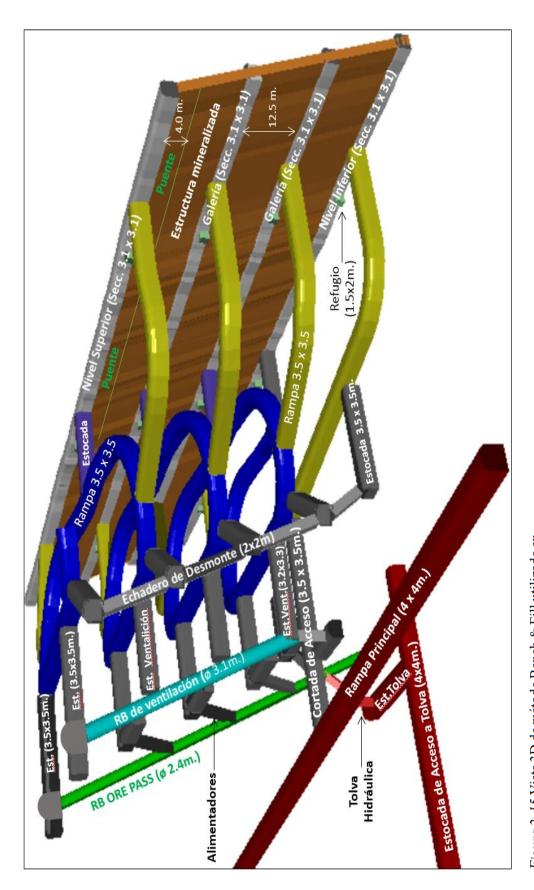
15. Vista 3D de método Bench & Fill utilizado en San Rafael
